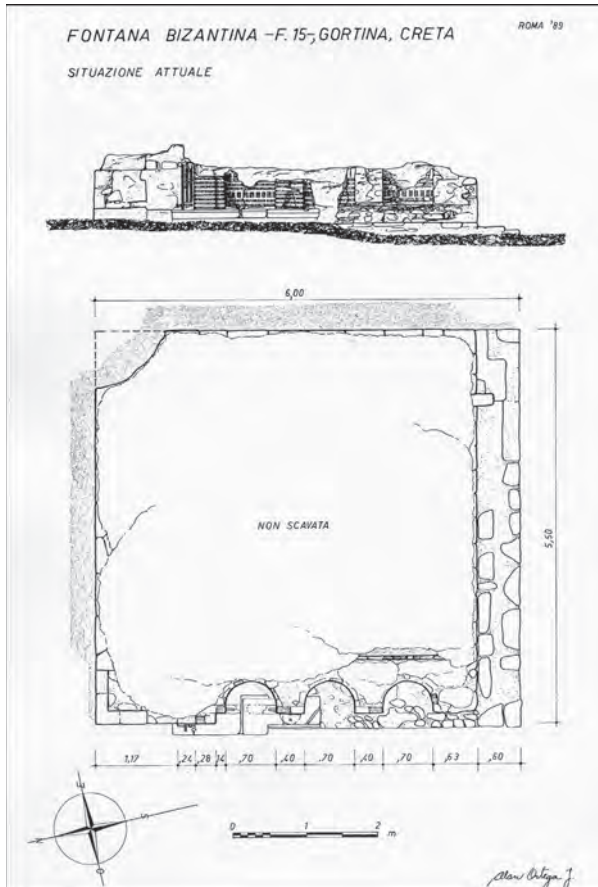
Planimetria e prospetto occidentale della cisterna/fontana nr. 98 (A. Ortega 1989, Archivio SAIA).
